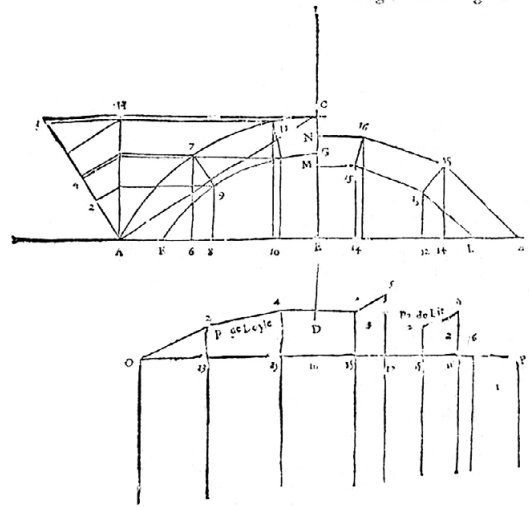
Trazado de la decenda de cava rebajada, por Jousse (1642, 58).
